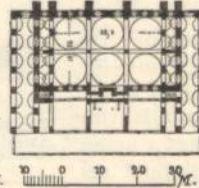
Grundriss. Piali Pascha Djami.
